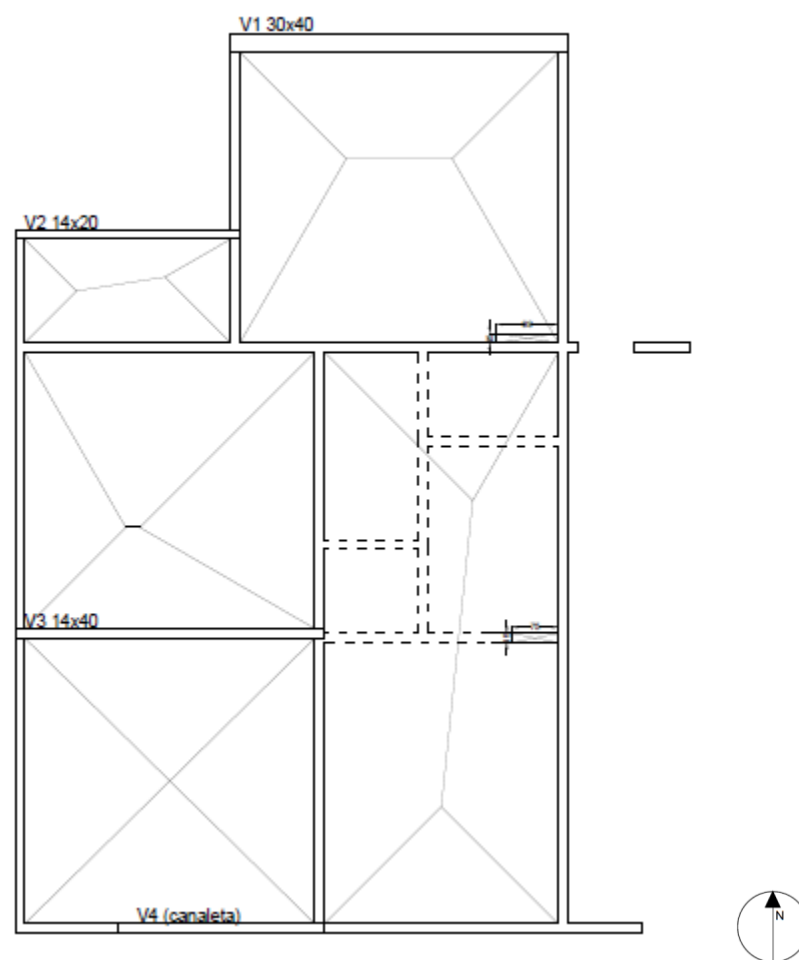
Área de influência de vigas para laje 1 Pavimento
